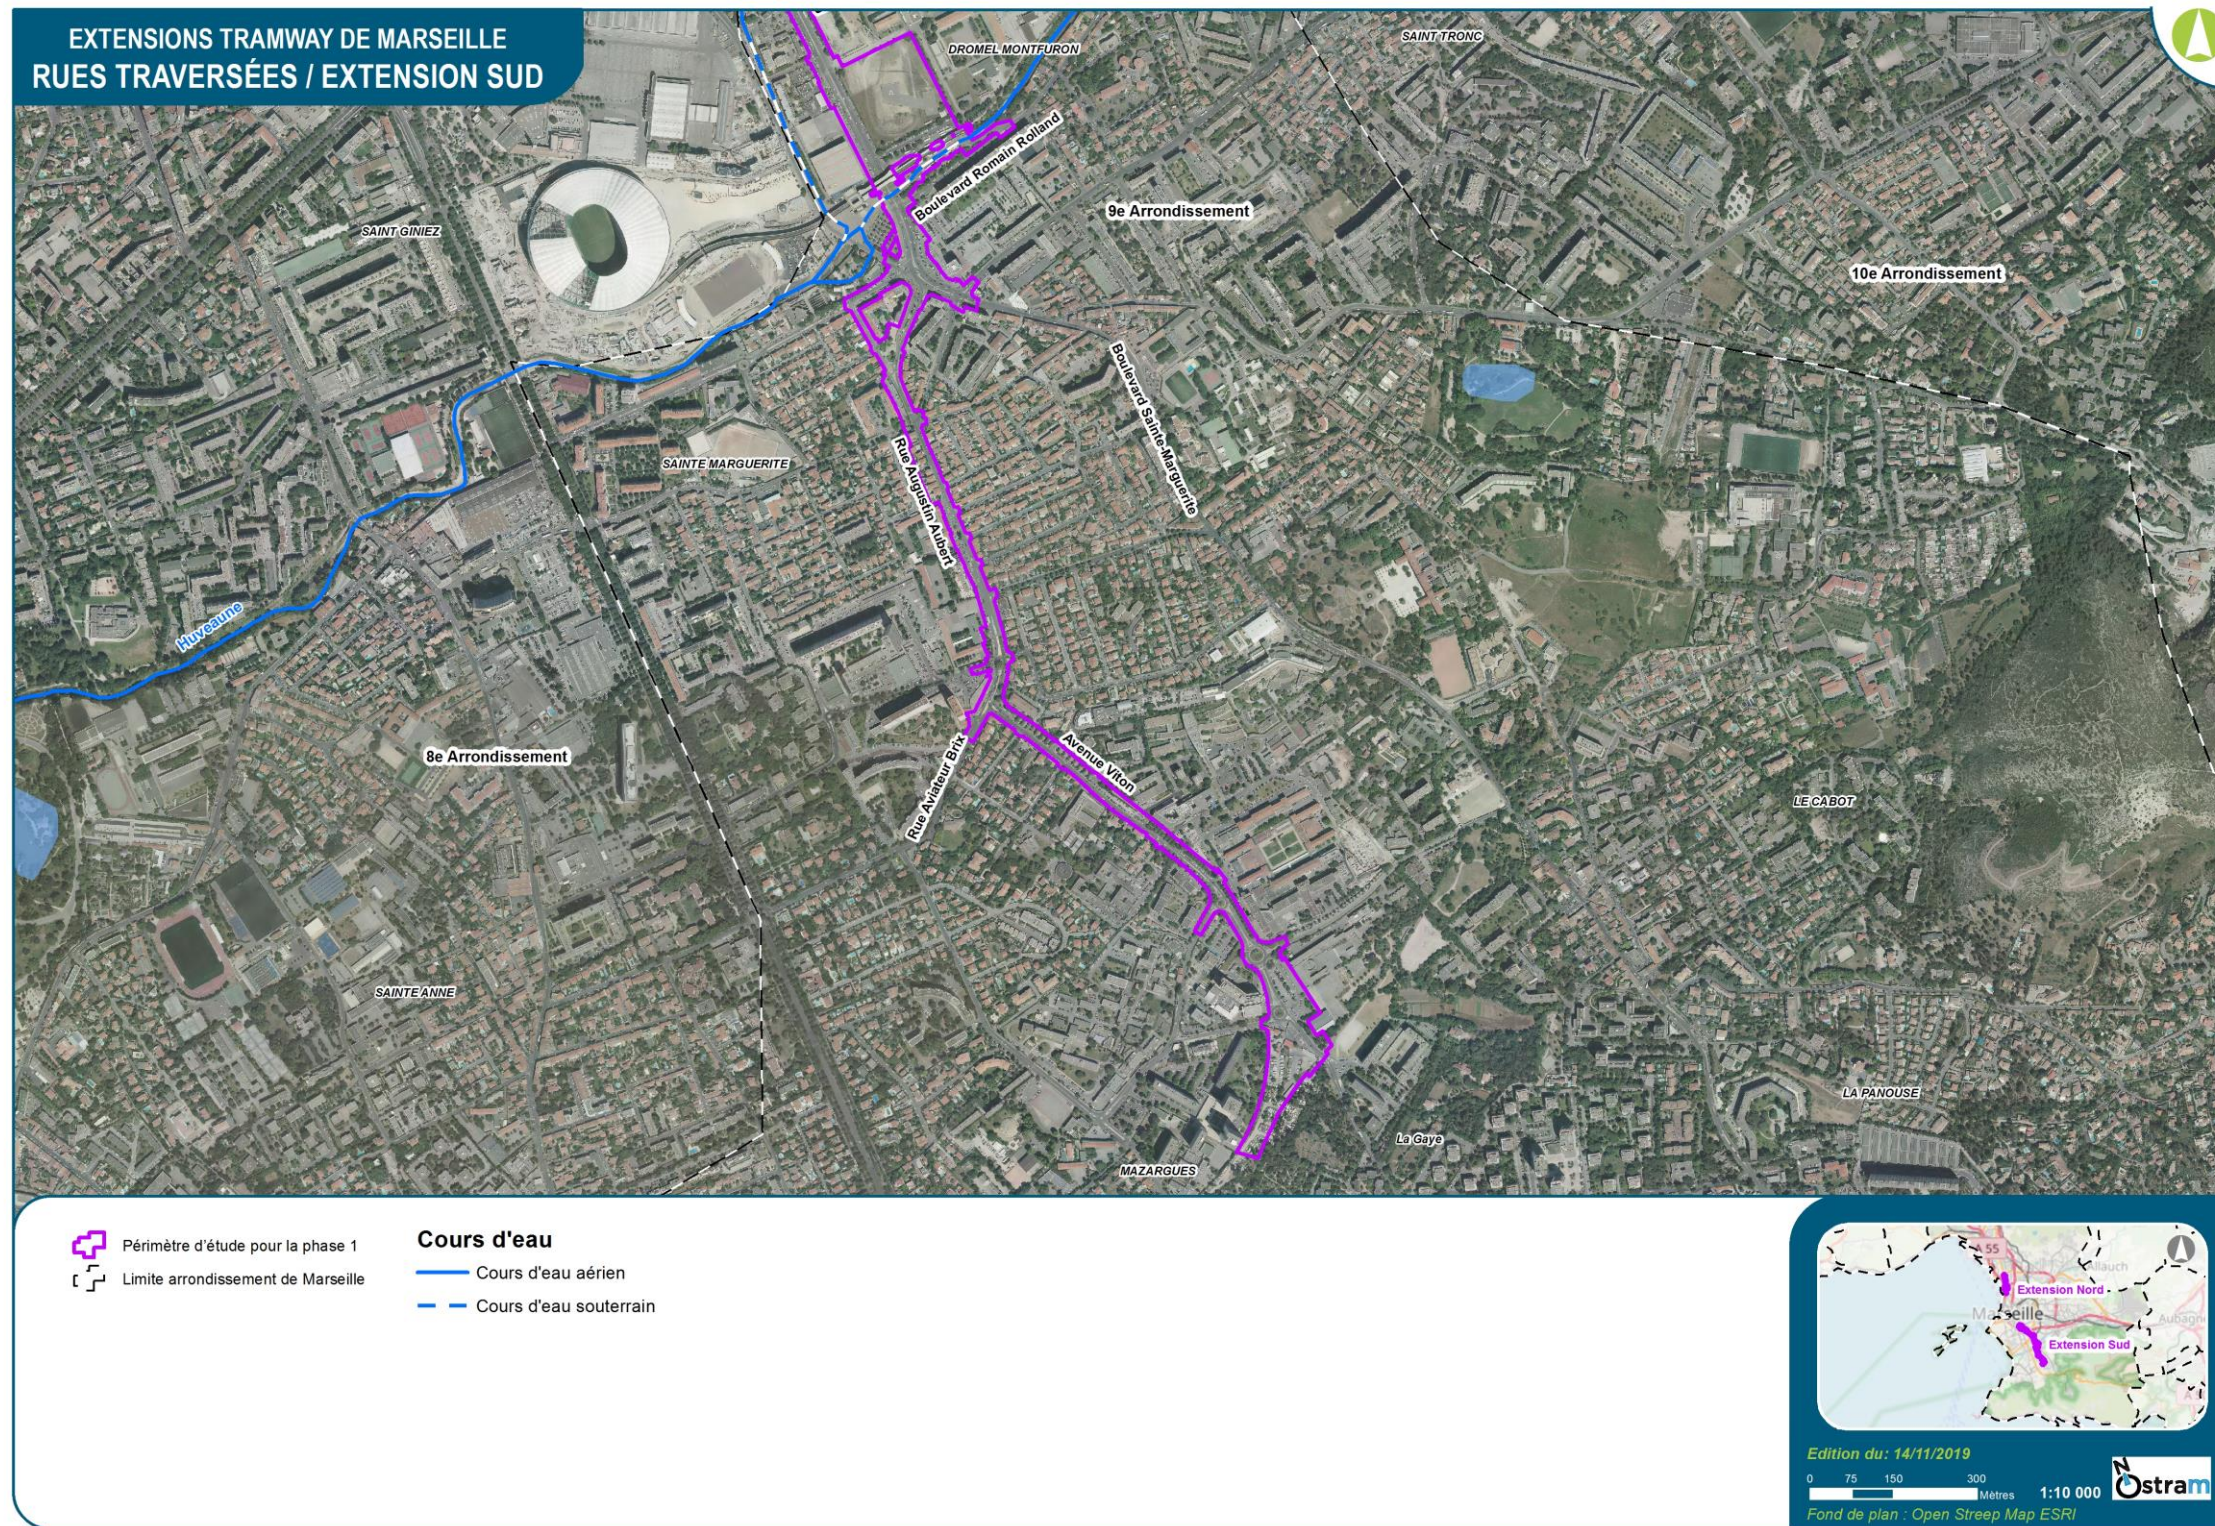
Plan des rues empruntées par l'extension Sud - Phase 1 du tramway – carte 2/2
